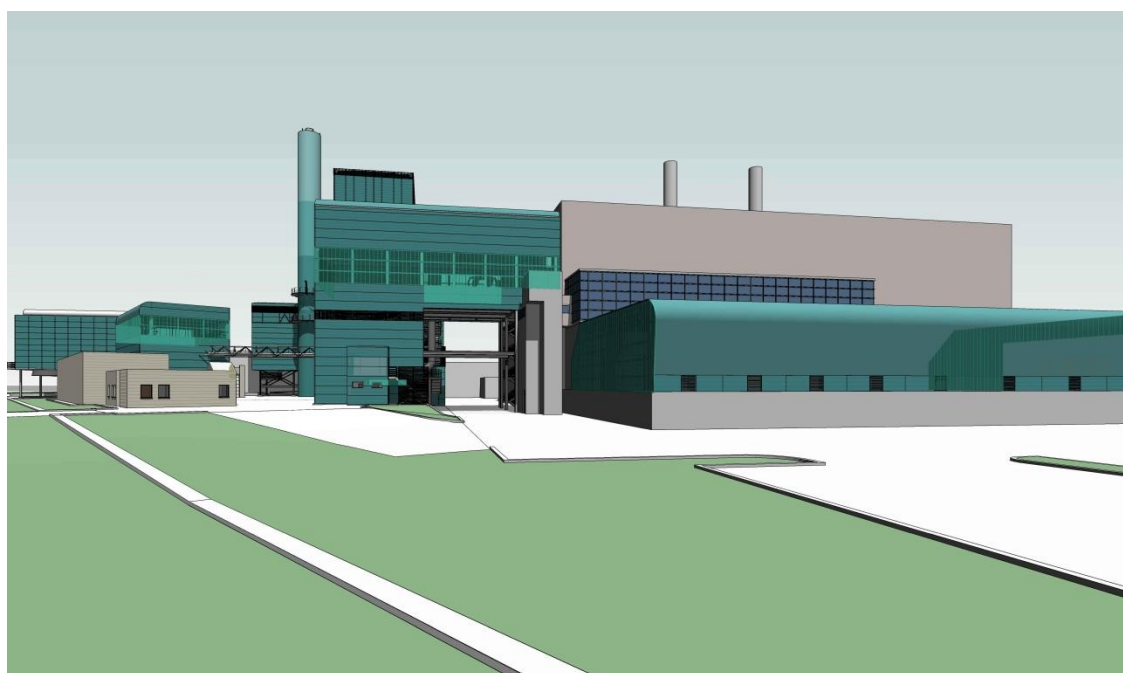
Vista prospettica di insieme dell'Impianto di progetto dalla viabilità esterna dell'area industriale Tossilo
